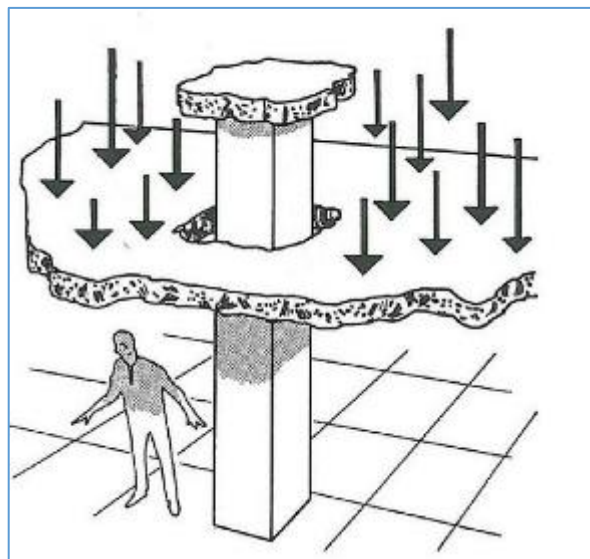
Falla por punzonamiento en la losa. Fuente: web
